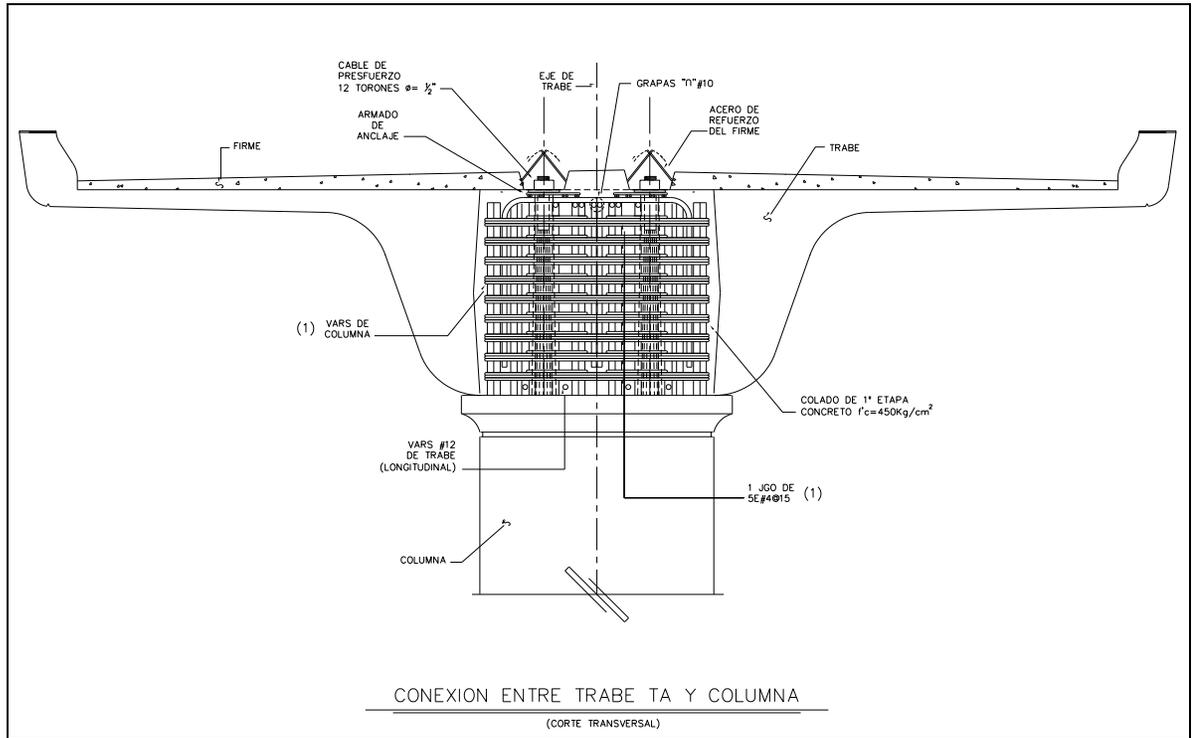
Detalle de Conexión entre Traves T9 con las Columnas A – 10 y A – 11.
